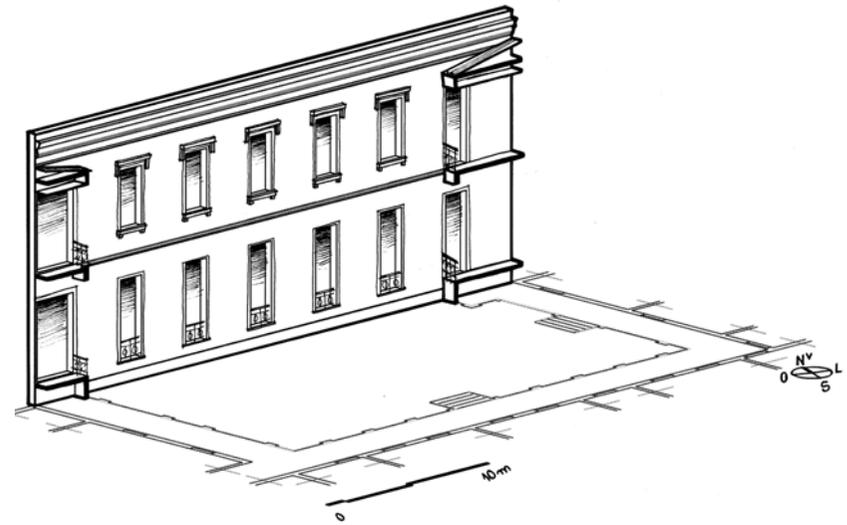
Estudo dos planos verticais, fachada Noroeste do pátio interno do CPIX.
